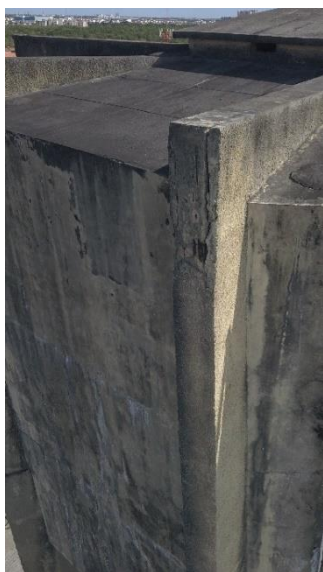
Deslocamento do concreto e corrosão da armadura na estrutura da cuba do reservatório.
